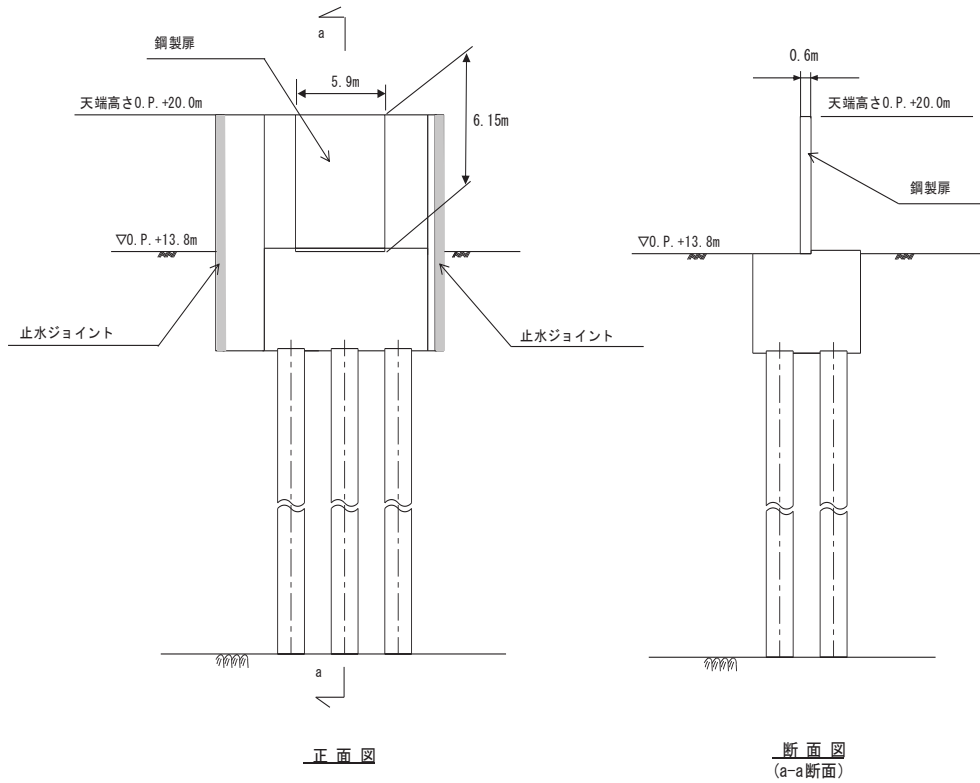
10. 4-28 鋼製扉 3 正面図及び断面図
